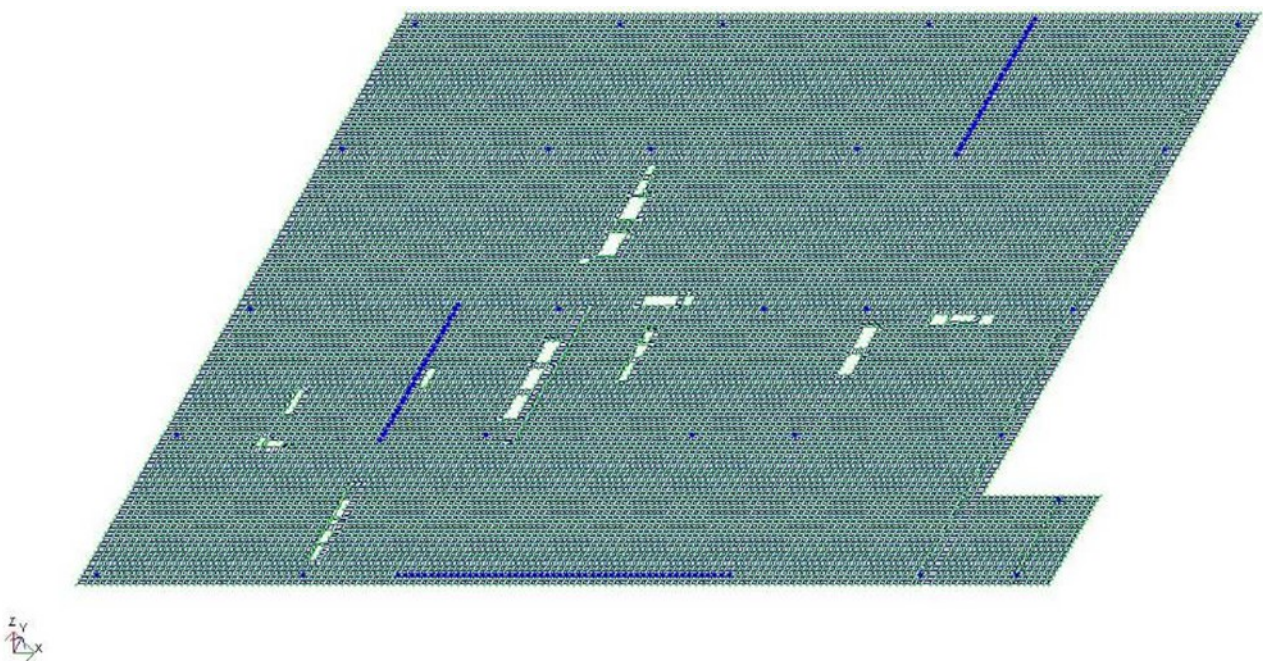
Розрахункова схема плити перекриття над 8 поверхом блоку Б в осях 1б-6б / ЖБ-А_{б/7}
